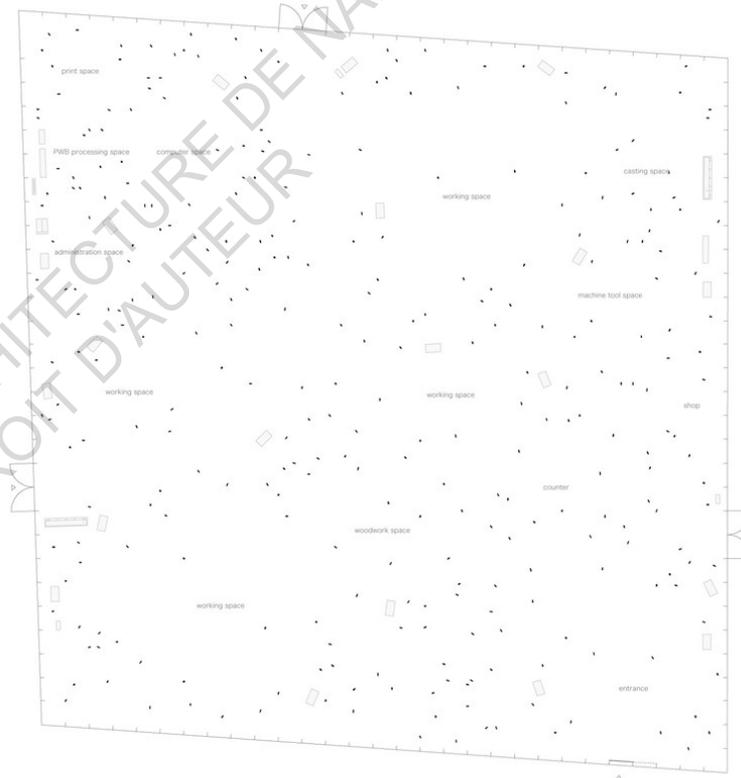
Plan du KAIT Workshop, par Junya Ishigami
